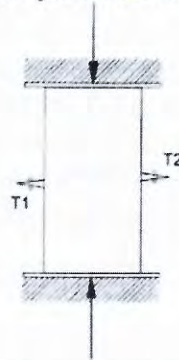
Схема испытания стеклопластикового образца коробчатого профиля
